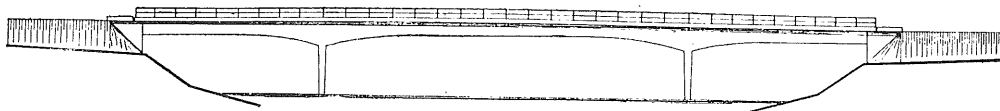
Alzado de un puente de hormigón armado, en pórtico continuo, con luces de 20,48 + 40,96 + 20,48 m.
